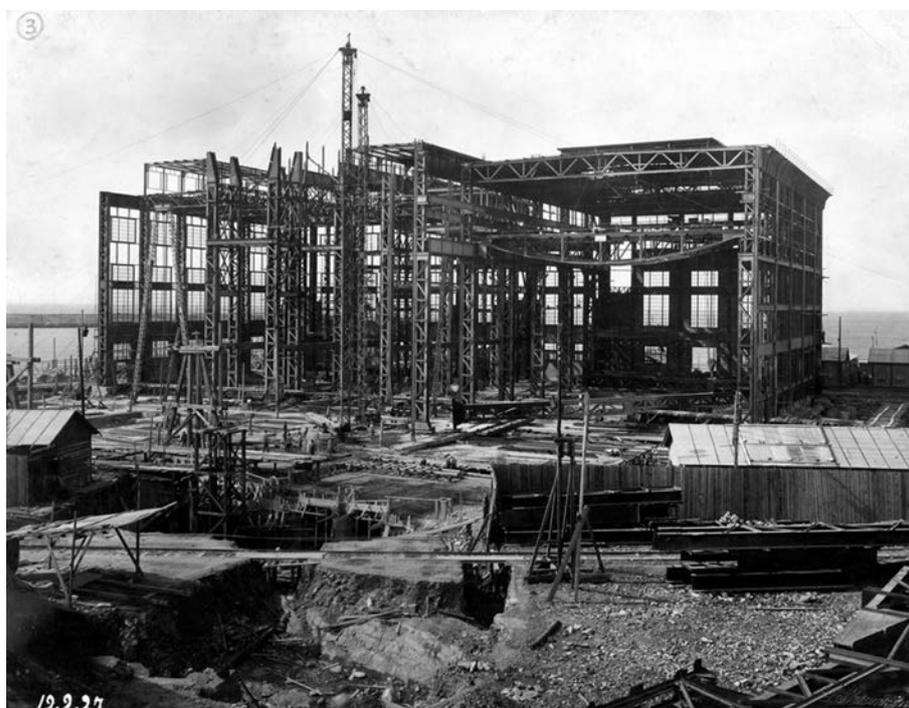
Construcción de la Central, 1927 (Archivo Enel)
